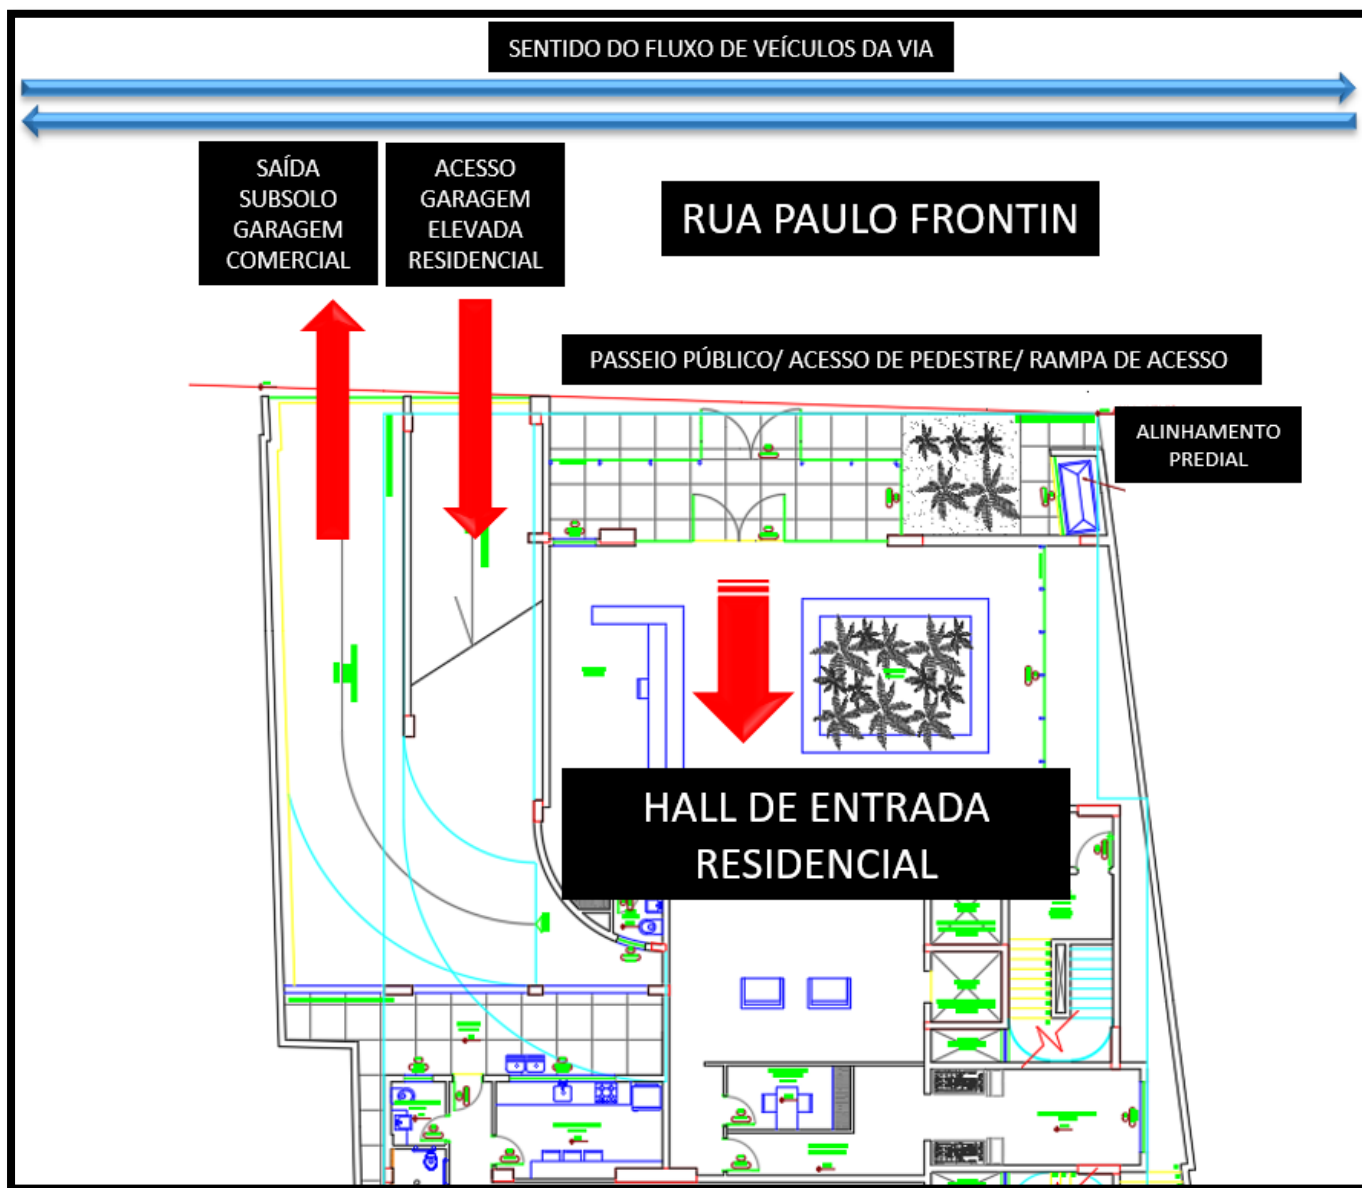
Acesso de pedestres Hall de entrada Residencial – Planta Baixa
